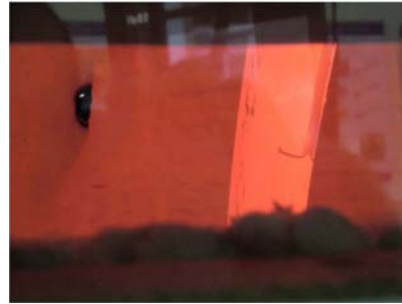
Final do ensaio, com o elemento ainda incandescente.
